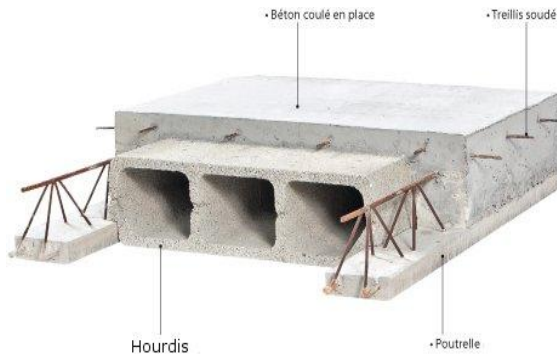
Plancher à corps creux (16+4) (source: <http://newbeams.blogspot.com/2012/11/plancher-16-4.html>)
